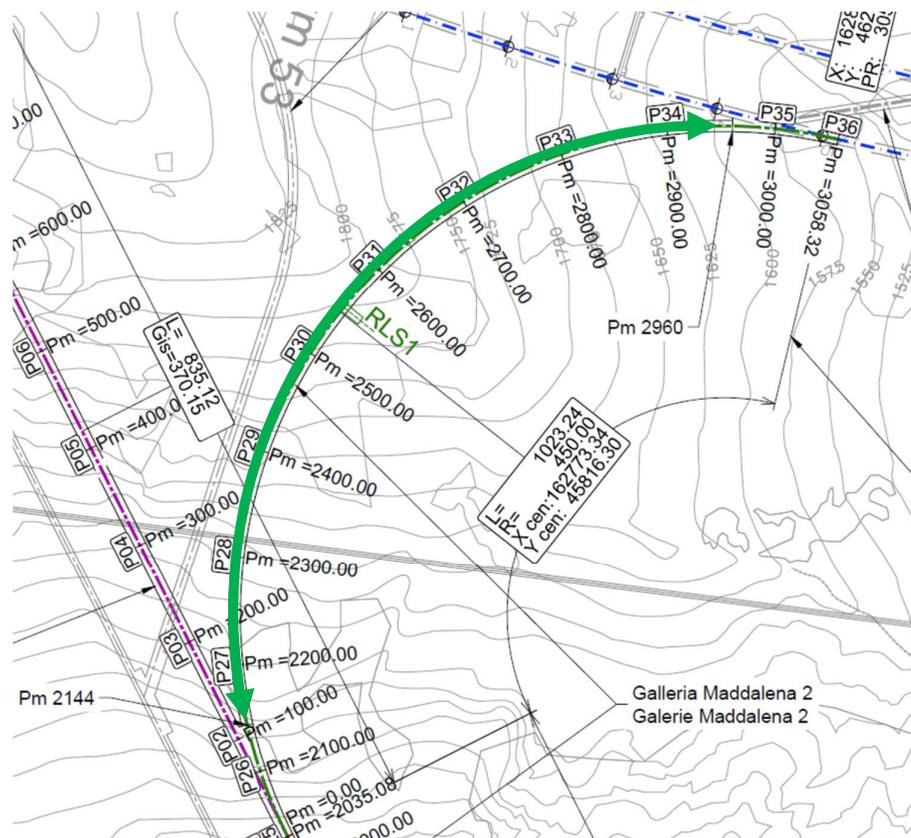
Planimetria delle zone di stoccaggio in Maddalena 2 (PRV\_C3A\_7520\_26-48-11)
